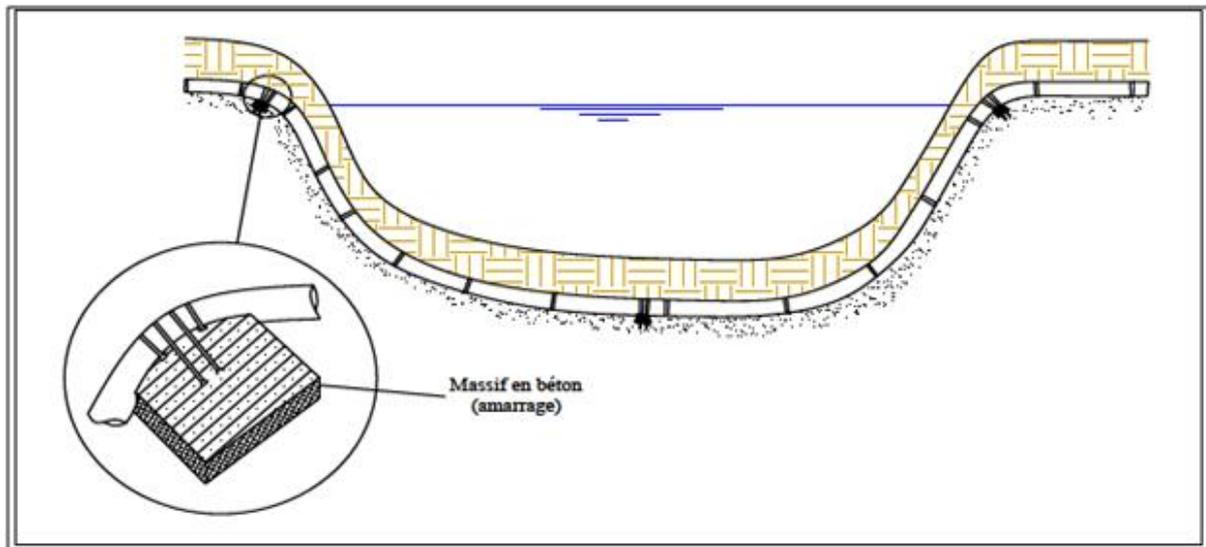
Pose de canalisation à la traversée d'une rivière.
